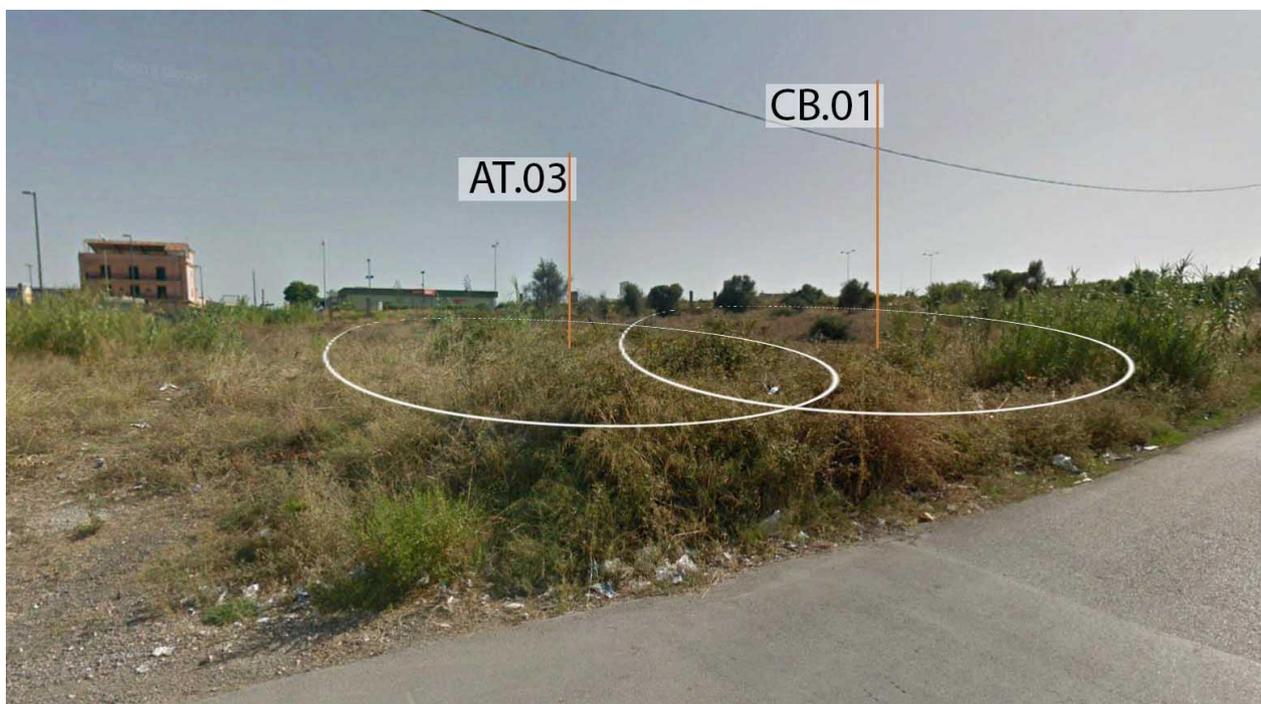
Ambiti olivati interessati temporaneamente dalle aree di cantiere fisso CB.01 e AT.03
